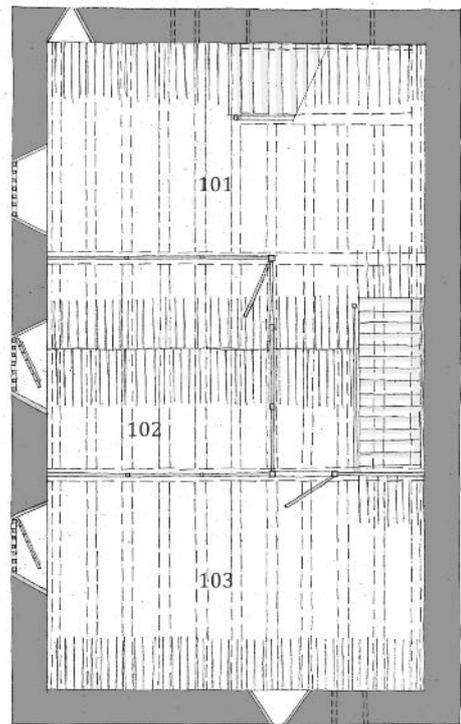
Grundriss Wachturm (1. OG), M 1:100
